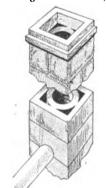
Ramin aus Beton: Wertfteinen mit Edenlüftung.
